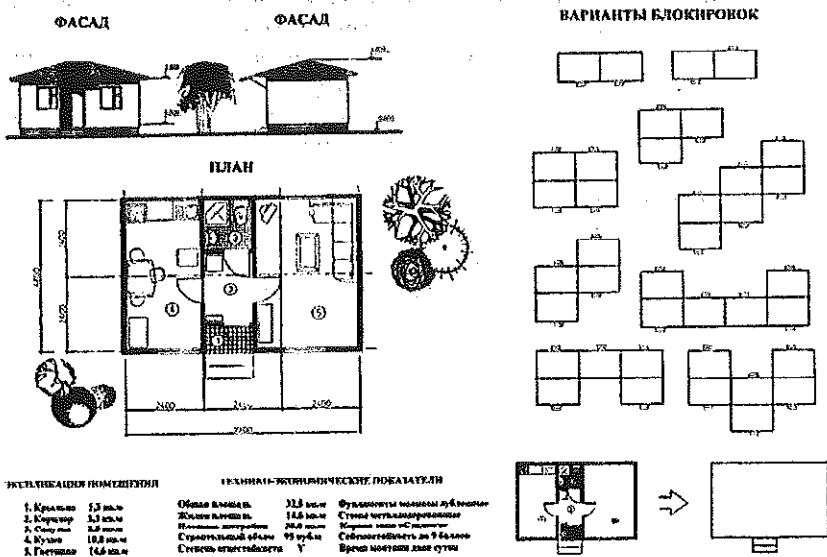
Блокированный быстровозводимый жилой дом общей площадью 32,5 кв.м. Фасады, план, варианты блокировок
